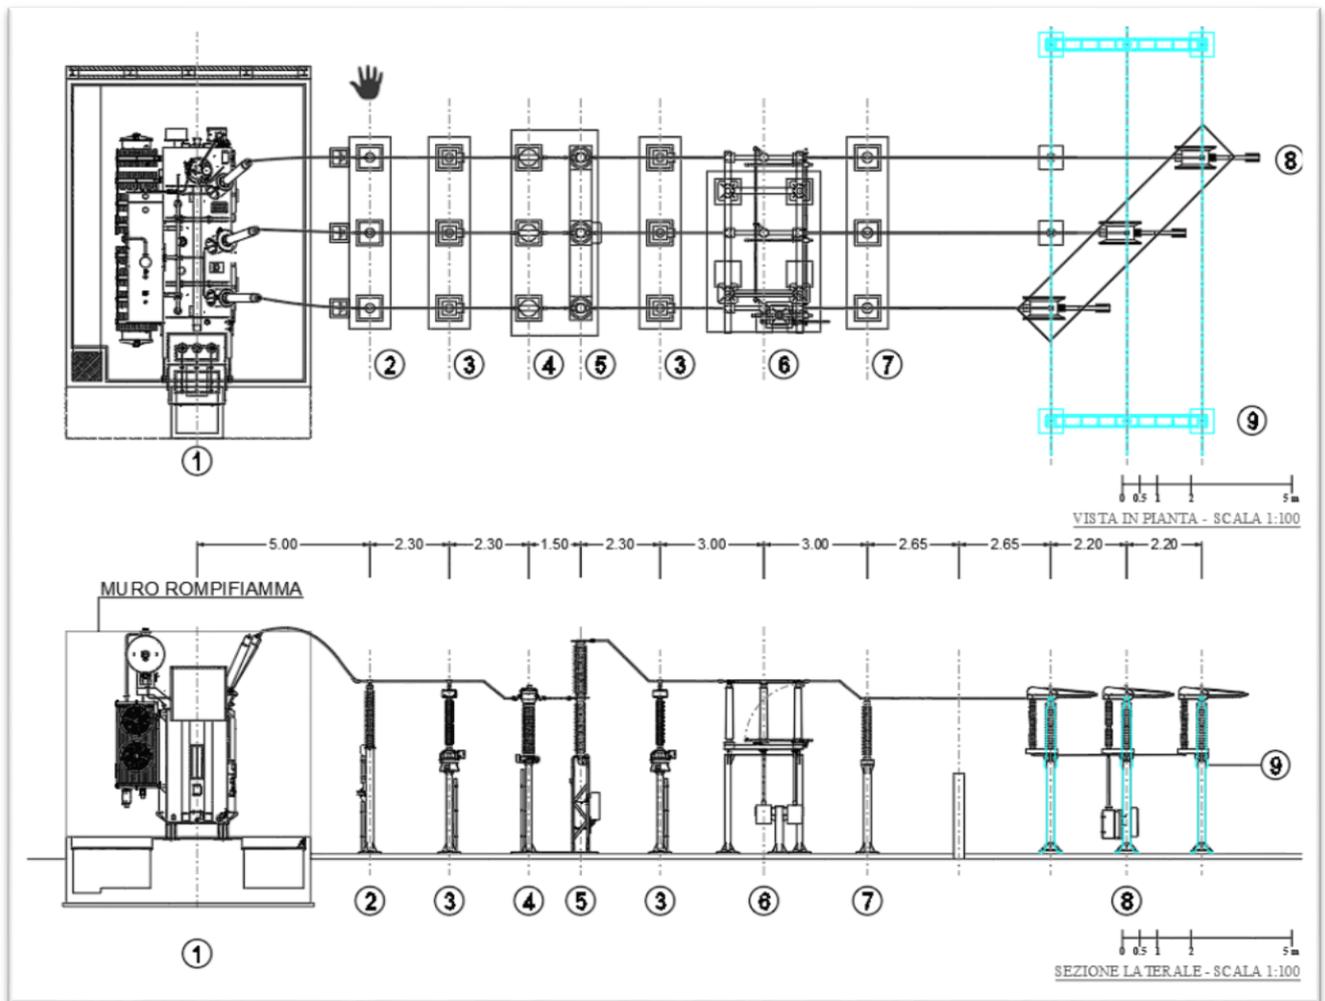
Planimetria elettromeccanica SSE di UtENZA
